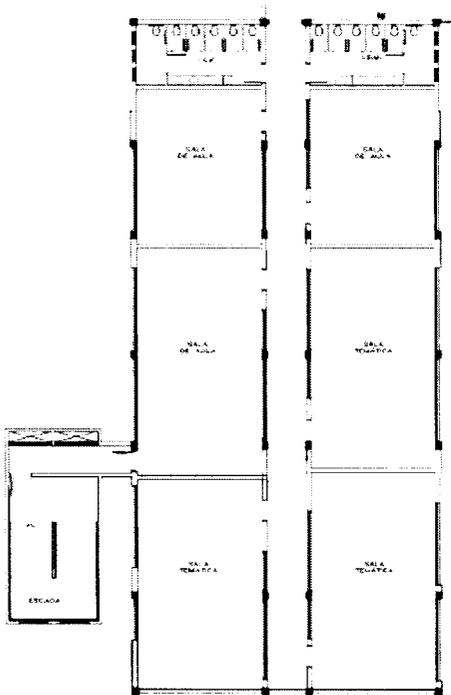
PLANTAS DO BLOCO DIDÁTICO “A”
